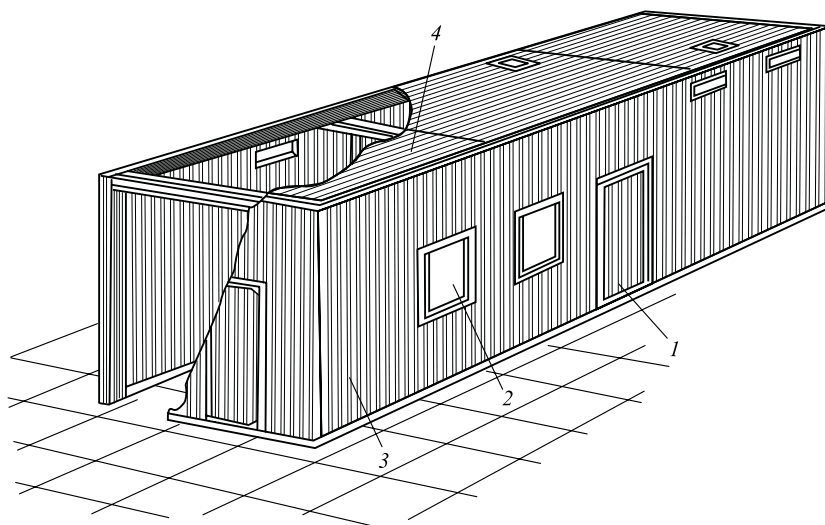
Индустриальное панельное электротехническое помещение:
